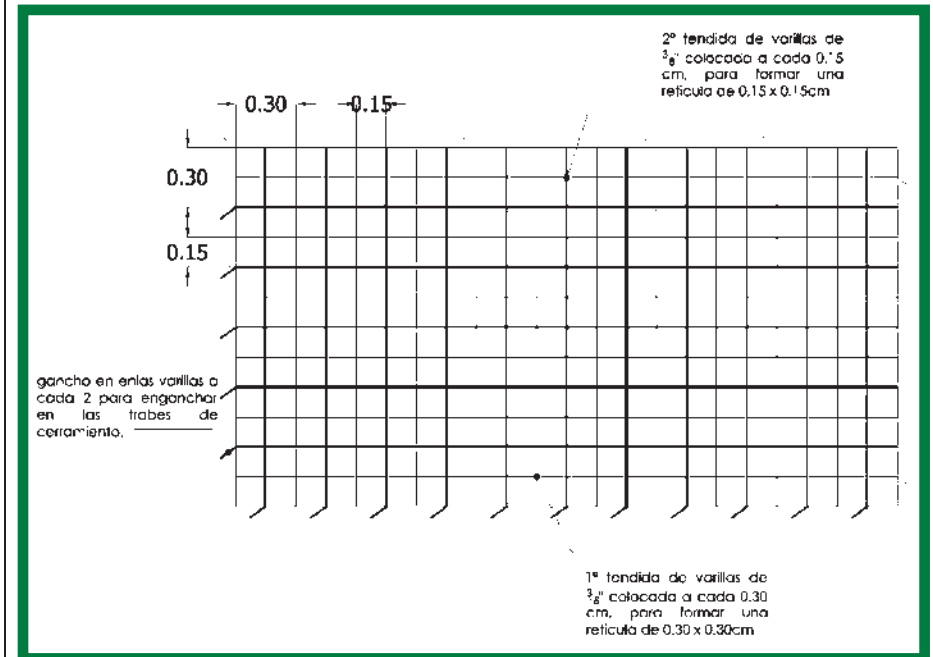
En esta imagen se observa de manera gráfica el armado estructural de las losas inclinadas. Creada por VMMG. Ver detalle en plano estructural
